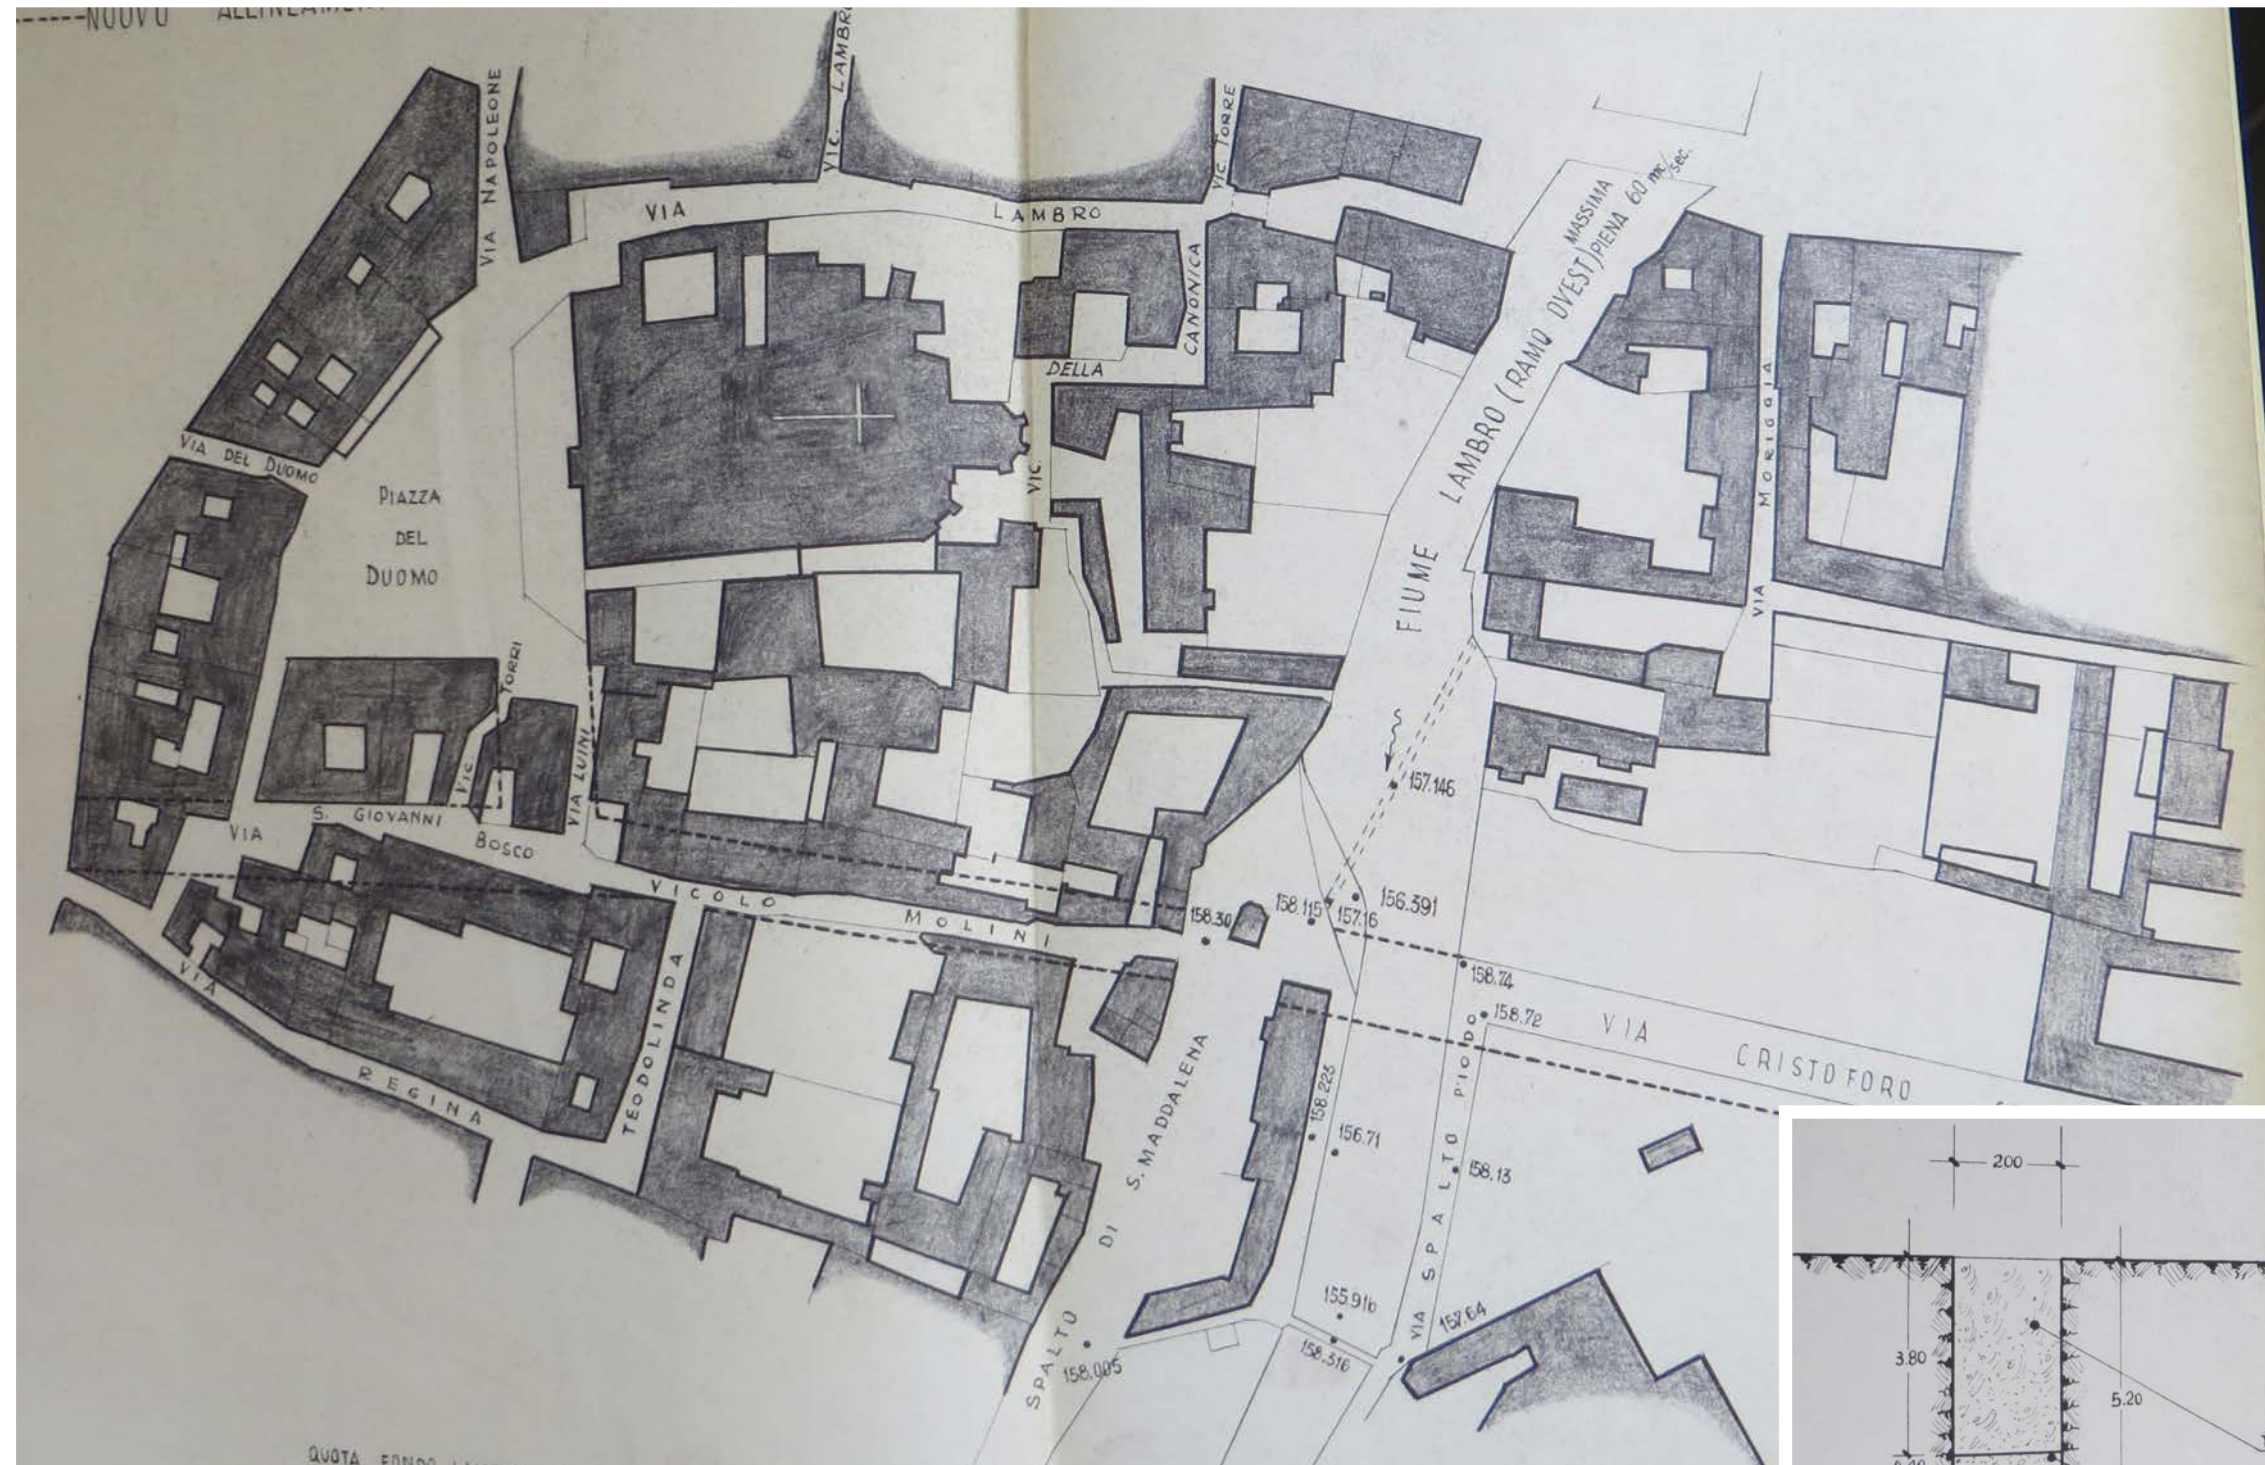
Planimetria della zona con tracciato di piano regolatore
